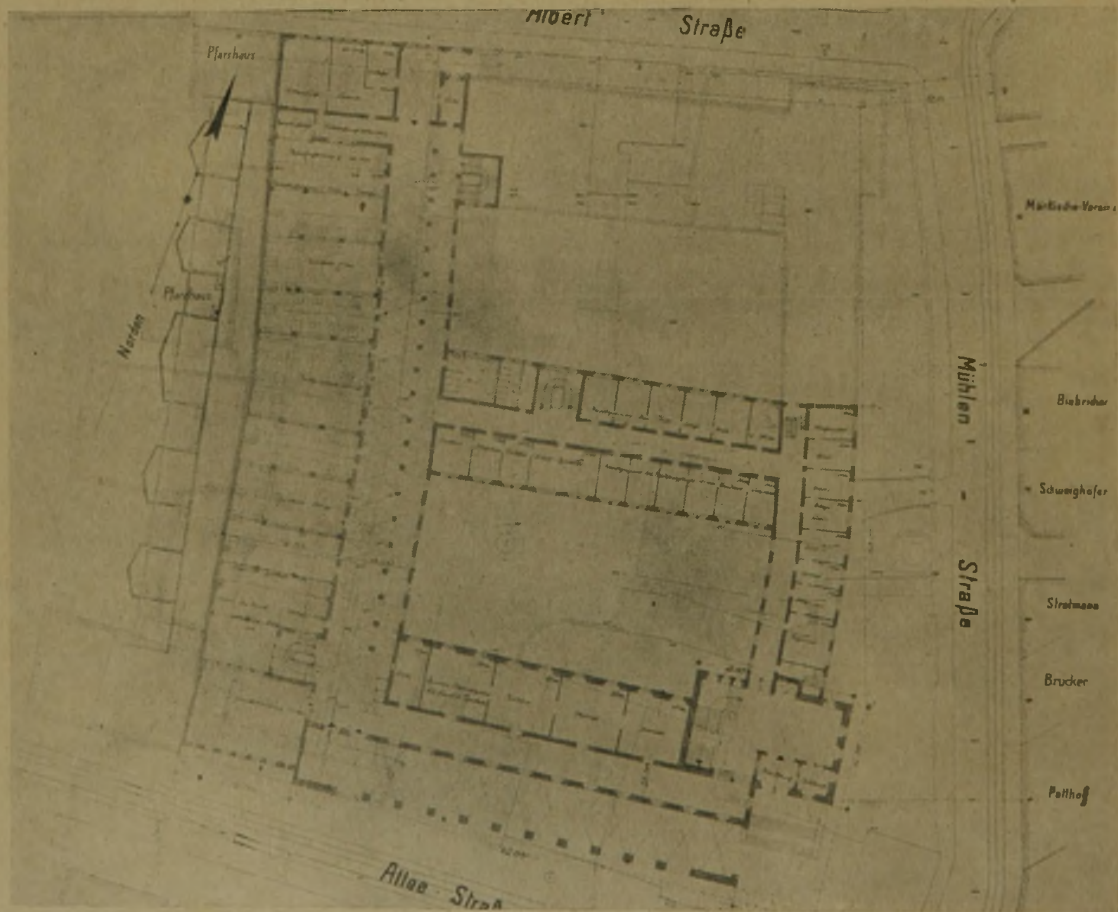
Erdgeschoßgrundriß (1:1000). Ein III. Preis von 7000 M. Kennwort: „Kassenhallen“.
